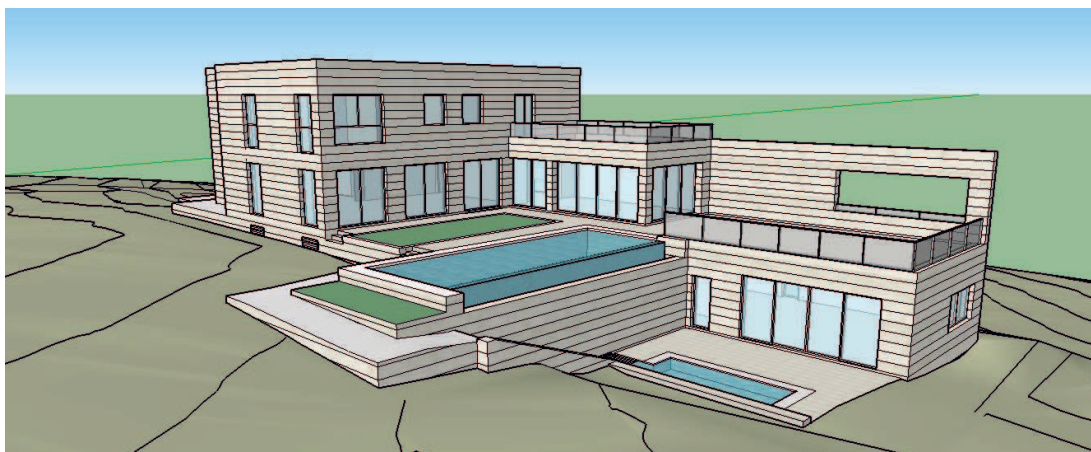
Modelação 3D: Fachadas sul e este (Sketchup)
